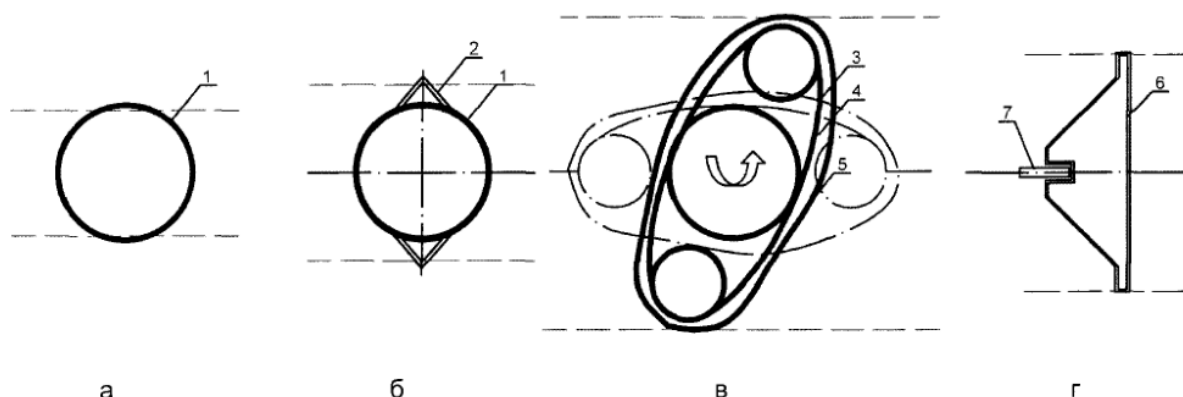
Варіанти перерізів найбільш поширених тимчасових обмежувачів захваток: а - круглої форми; б - з ущільнювачами; в - еліпсоподібний поворотний; г - трапецієподібний з ватерстопом; 1 - труба; 2 - кутик; 3 - обшивка; 4 - консистентне мастило; 5 - захисний плівковий чохол; 6 - металевий корпус; 7 - ватерстоп
